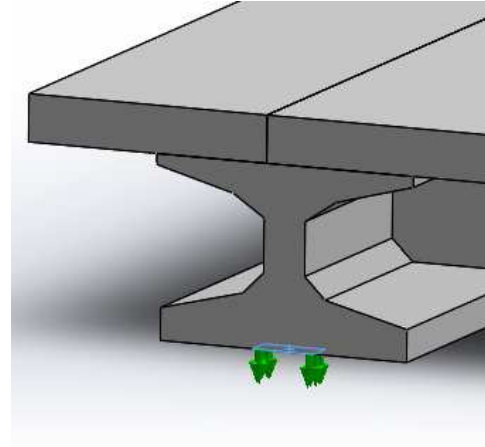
Coacción de apoyo tipo deslizante libre directamente sobre viga, SolidWorks.
